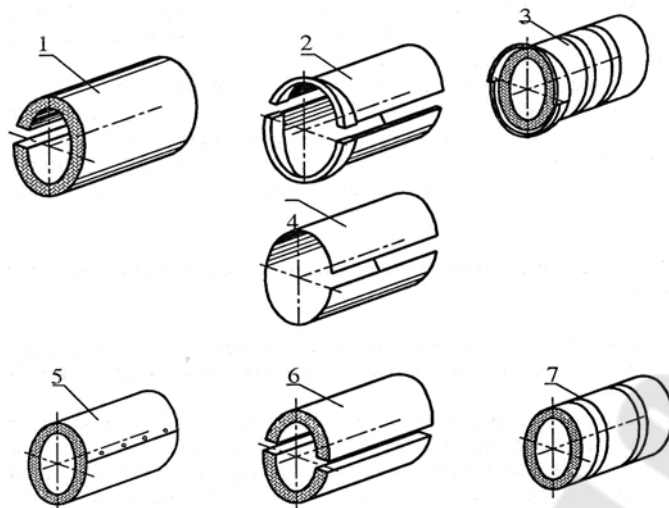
Полноборные теплоизоляционные конструкции: 1 - минеральный цилиндр; 2 - асбестоцементный полуцилиндр; 3 - полноборная конструкция из минерале ватного цилиндра и асбестоцементных полуцилиндров; 4 - металлическое покрытие; 5 - полноборная конструкция из минераловатного цилиндра и покрытия, скрепленного самонарезающими винтами; 6 - жесткие полуцилиндры; 7 - полноборная конструкция из полуцилиндров с покрытием пленкой, стянутая стальными бандажами
